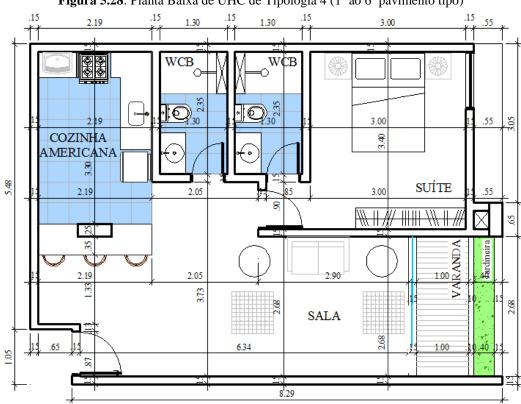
Planta Baixa de UHC de Tipologia 4 (1º ao 6º pavimento tipo)
